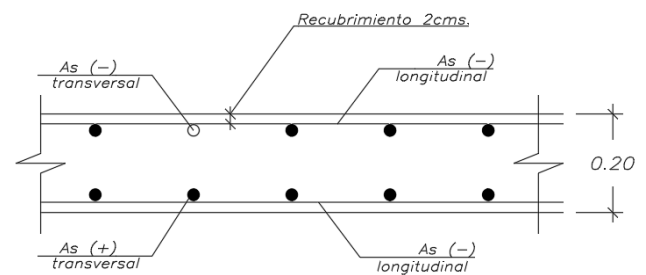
Sección transversal de la losa aligerada bidireccional H=20cm
